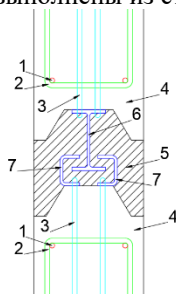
Разрабатываемое узловое соединение в плане.
